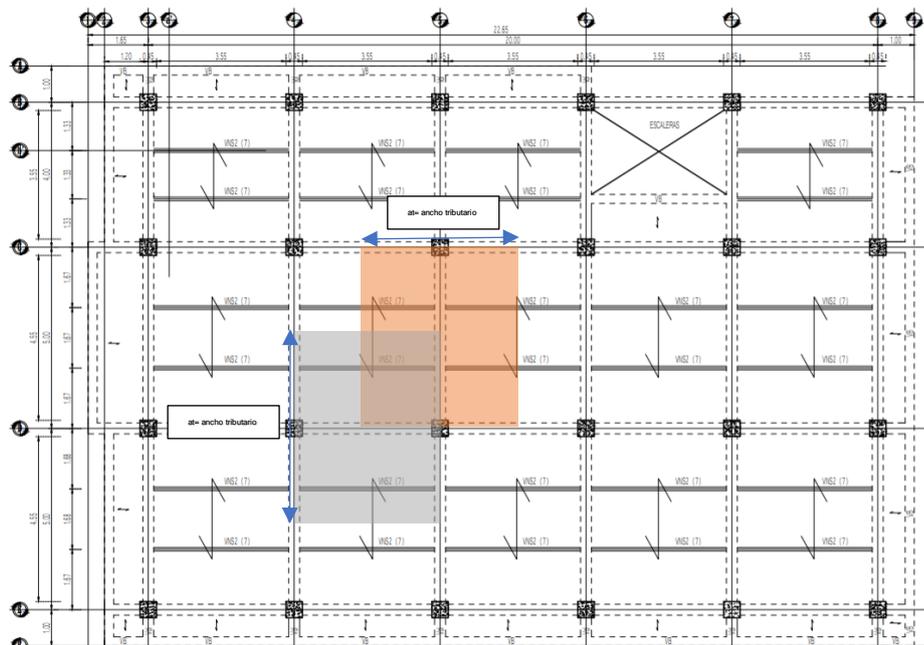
Ancho tributario por viga [López y Orosco, 2020]
